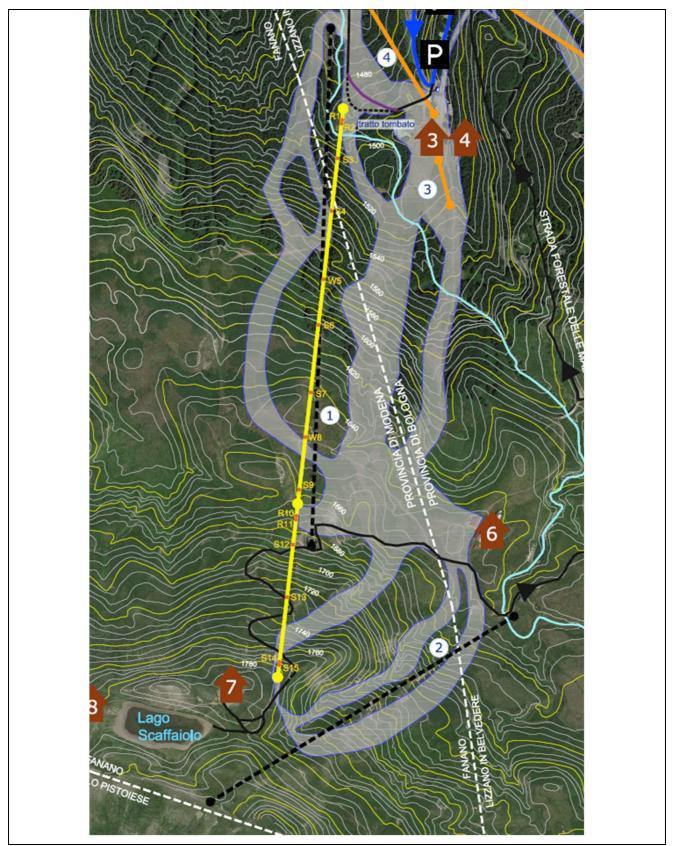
Localizzazione dell'impianto in progetto (in giallo) e degli impianti da rimuovere (tratteggiati in nero)
